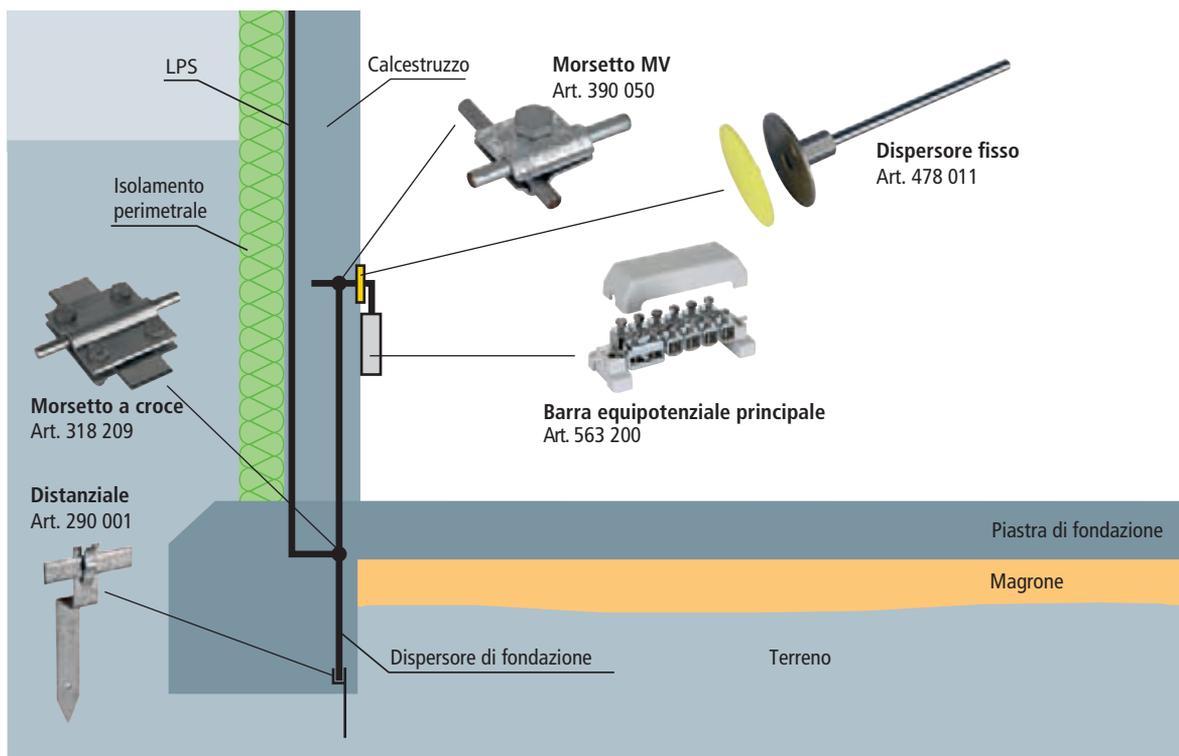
Disposizione del dispersore di fondazione con fondazione a nastro (muro di fondazione isolato)
